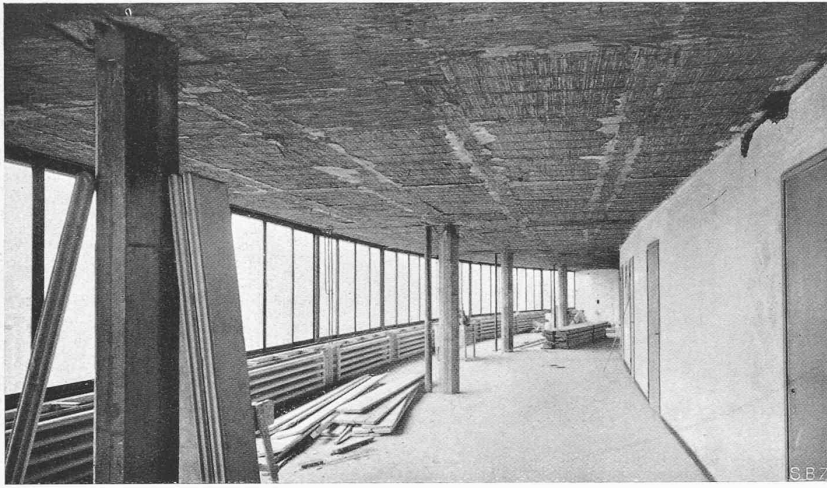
(oben). Bureau-Geschoss, Innenbild. — Abb. 33. Decken-Grundriss 1 : 400, Schnitte 1 : 200.
